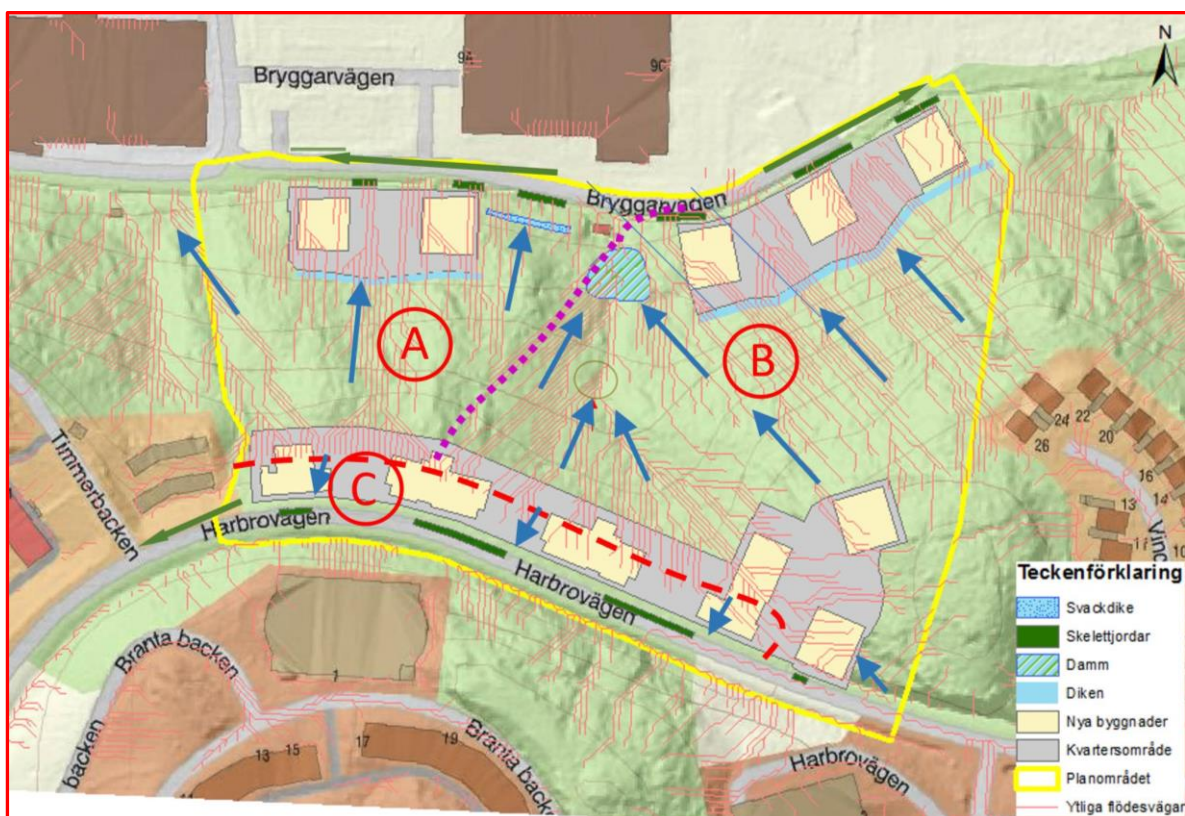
Planområdet med planerad kvartersmark och planerade byggnader
